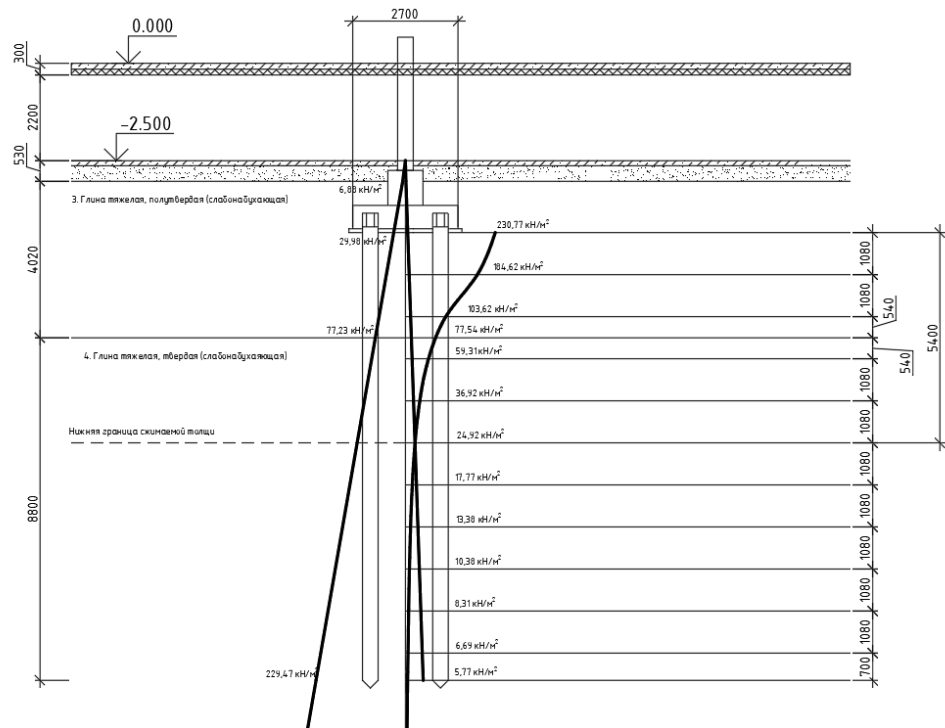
Расчетная схема осадки свайного фундамента
